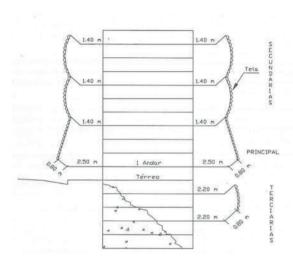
Plataforma de proteção com pavimento no subsolo Fonte: FUNDACENTRO. 2003
